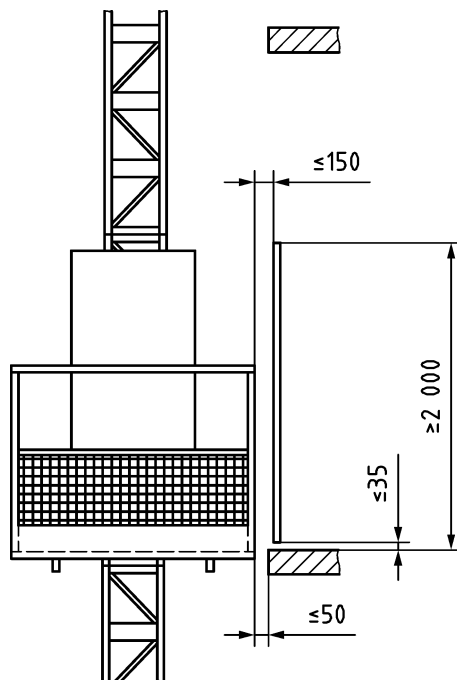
Beispiel für ein Ladestellentor mit voller Höhe
